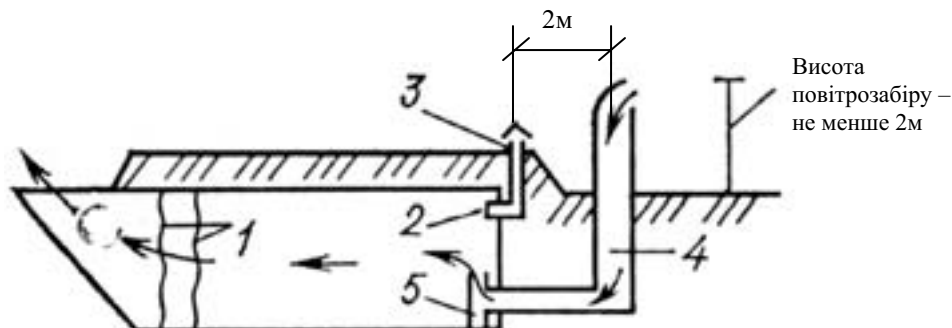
Принципова схема повітропостачання ПРУ: 1 – завіса; 2 – витяжний короб; 3 – оголовок витяжної вентиляції; 4 – забірний короб; 5 – засувка.
